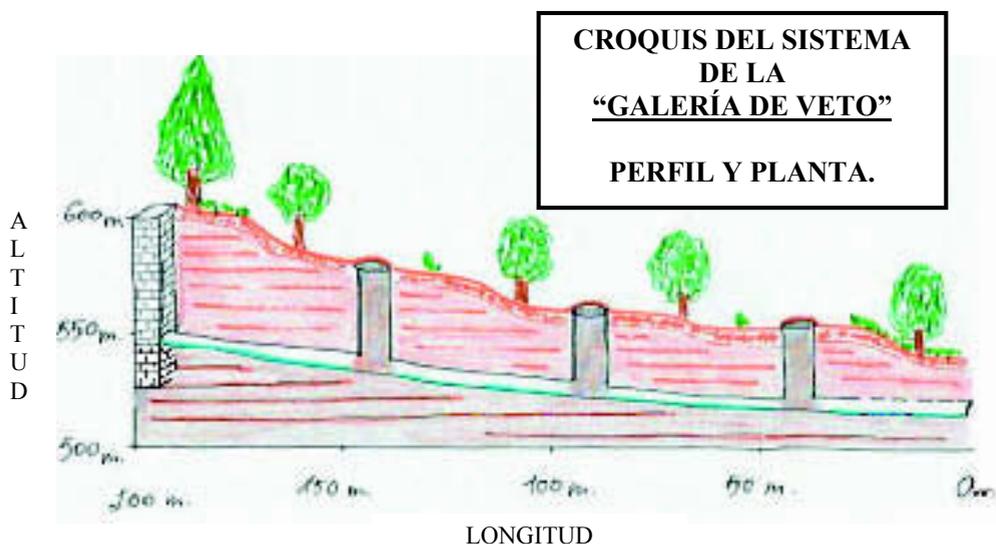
Sistema de la galería de Veto (Croquis de perfil y planta).
